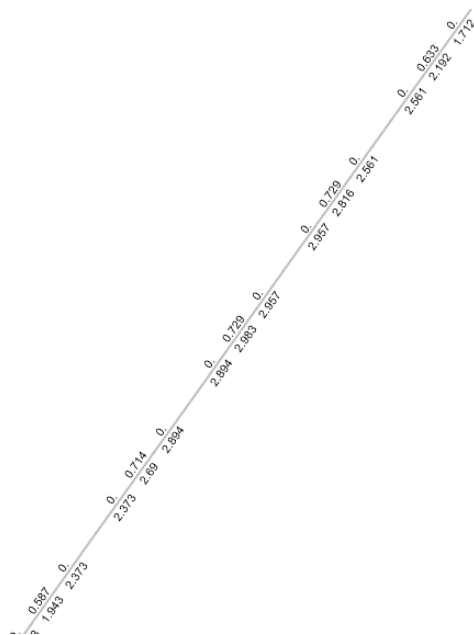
Acero longitudinal As(+) primer tramo en SAP200 de la escalera
